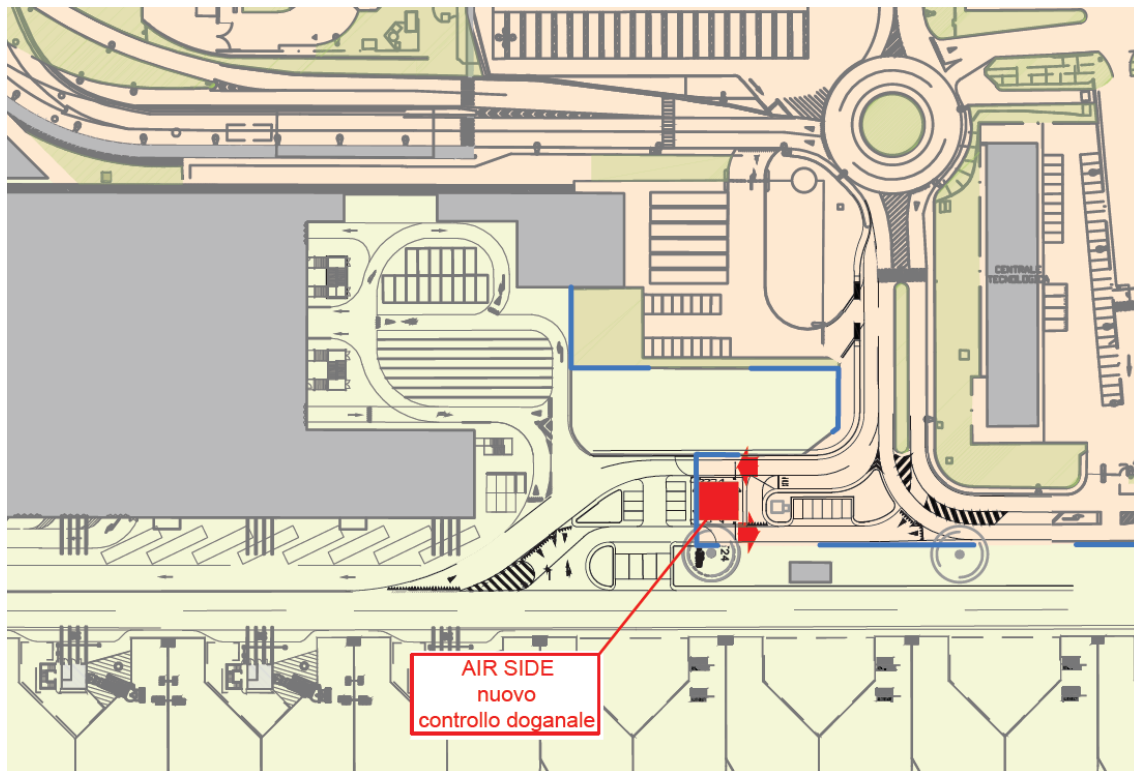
Planimetria ubicazione nuovo varco doganale
